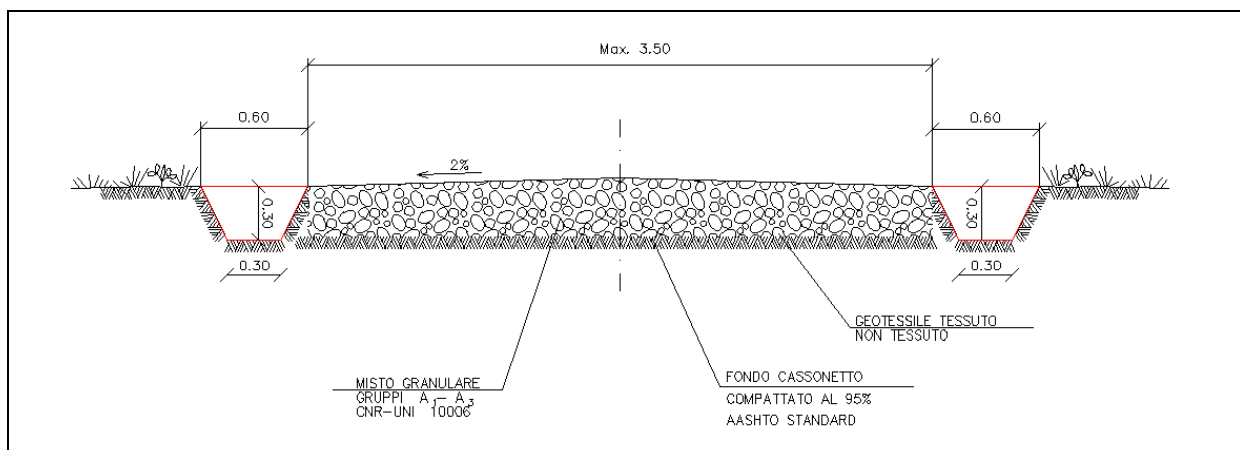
Sezione trasversale strada di collegamento con cunette
